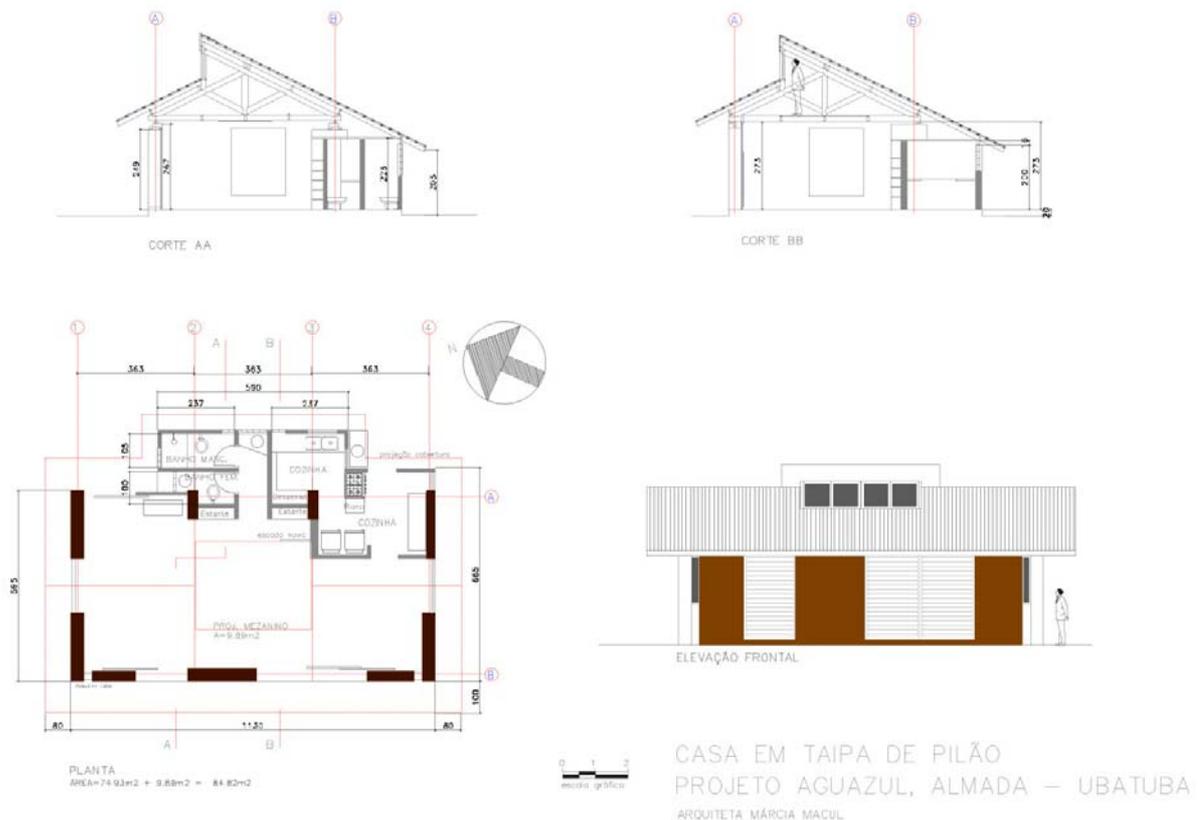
Cortes, planta baixa e vista da casa do Projeto Aguazul
